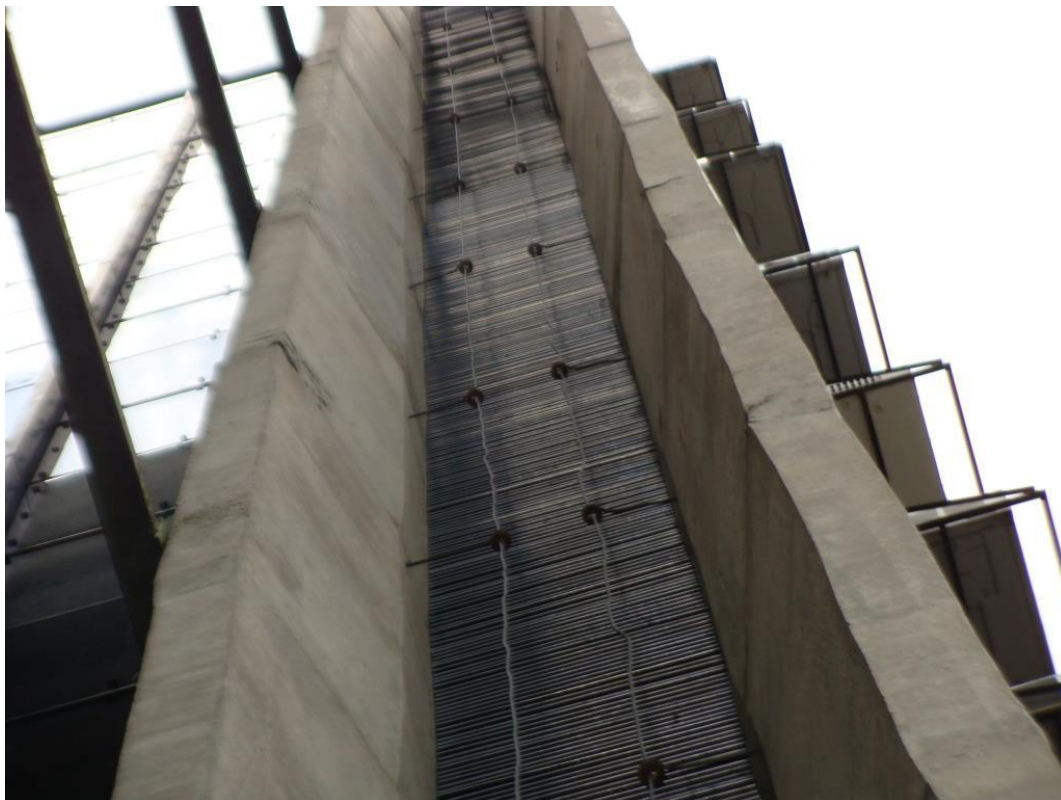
Armadura exposta Pilar P7 (02/03/2021)
